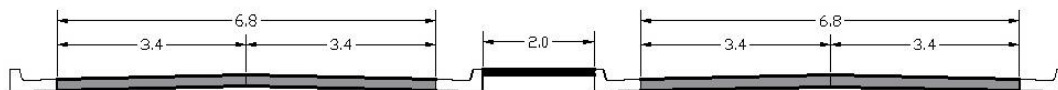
Sección transversal tipo del camino de ingreso, para ingreso y egreso.
